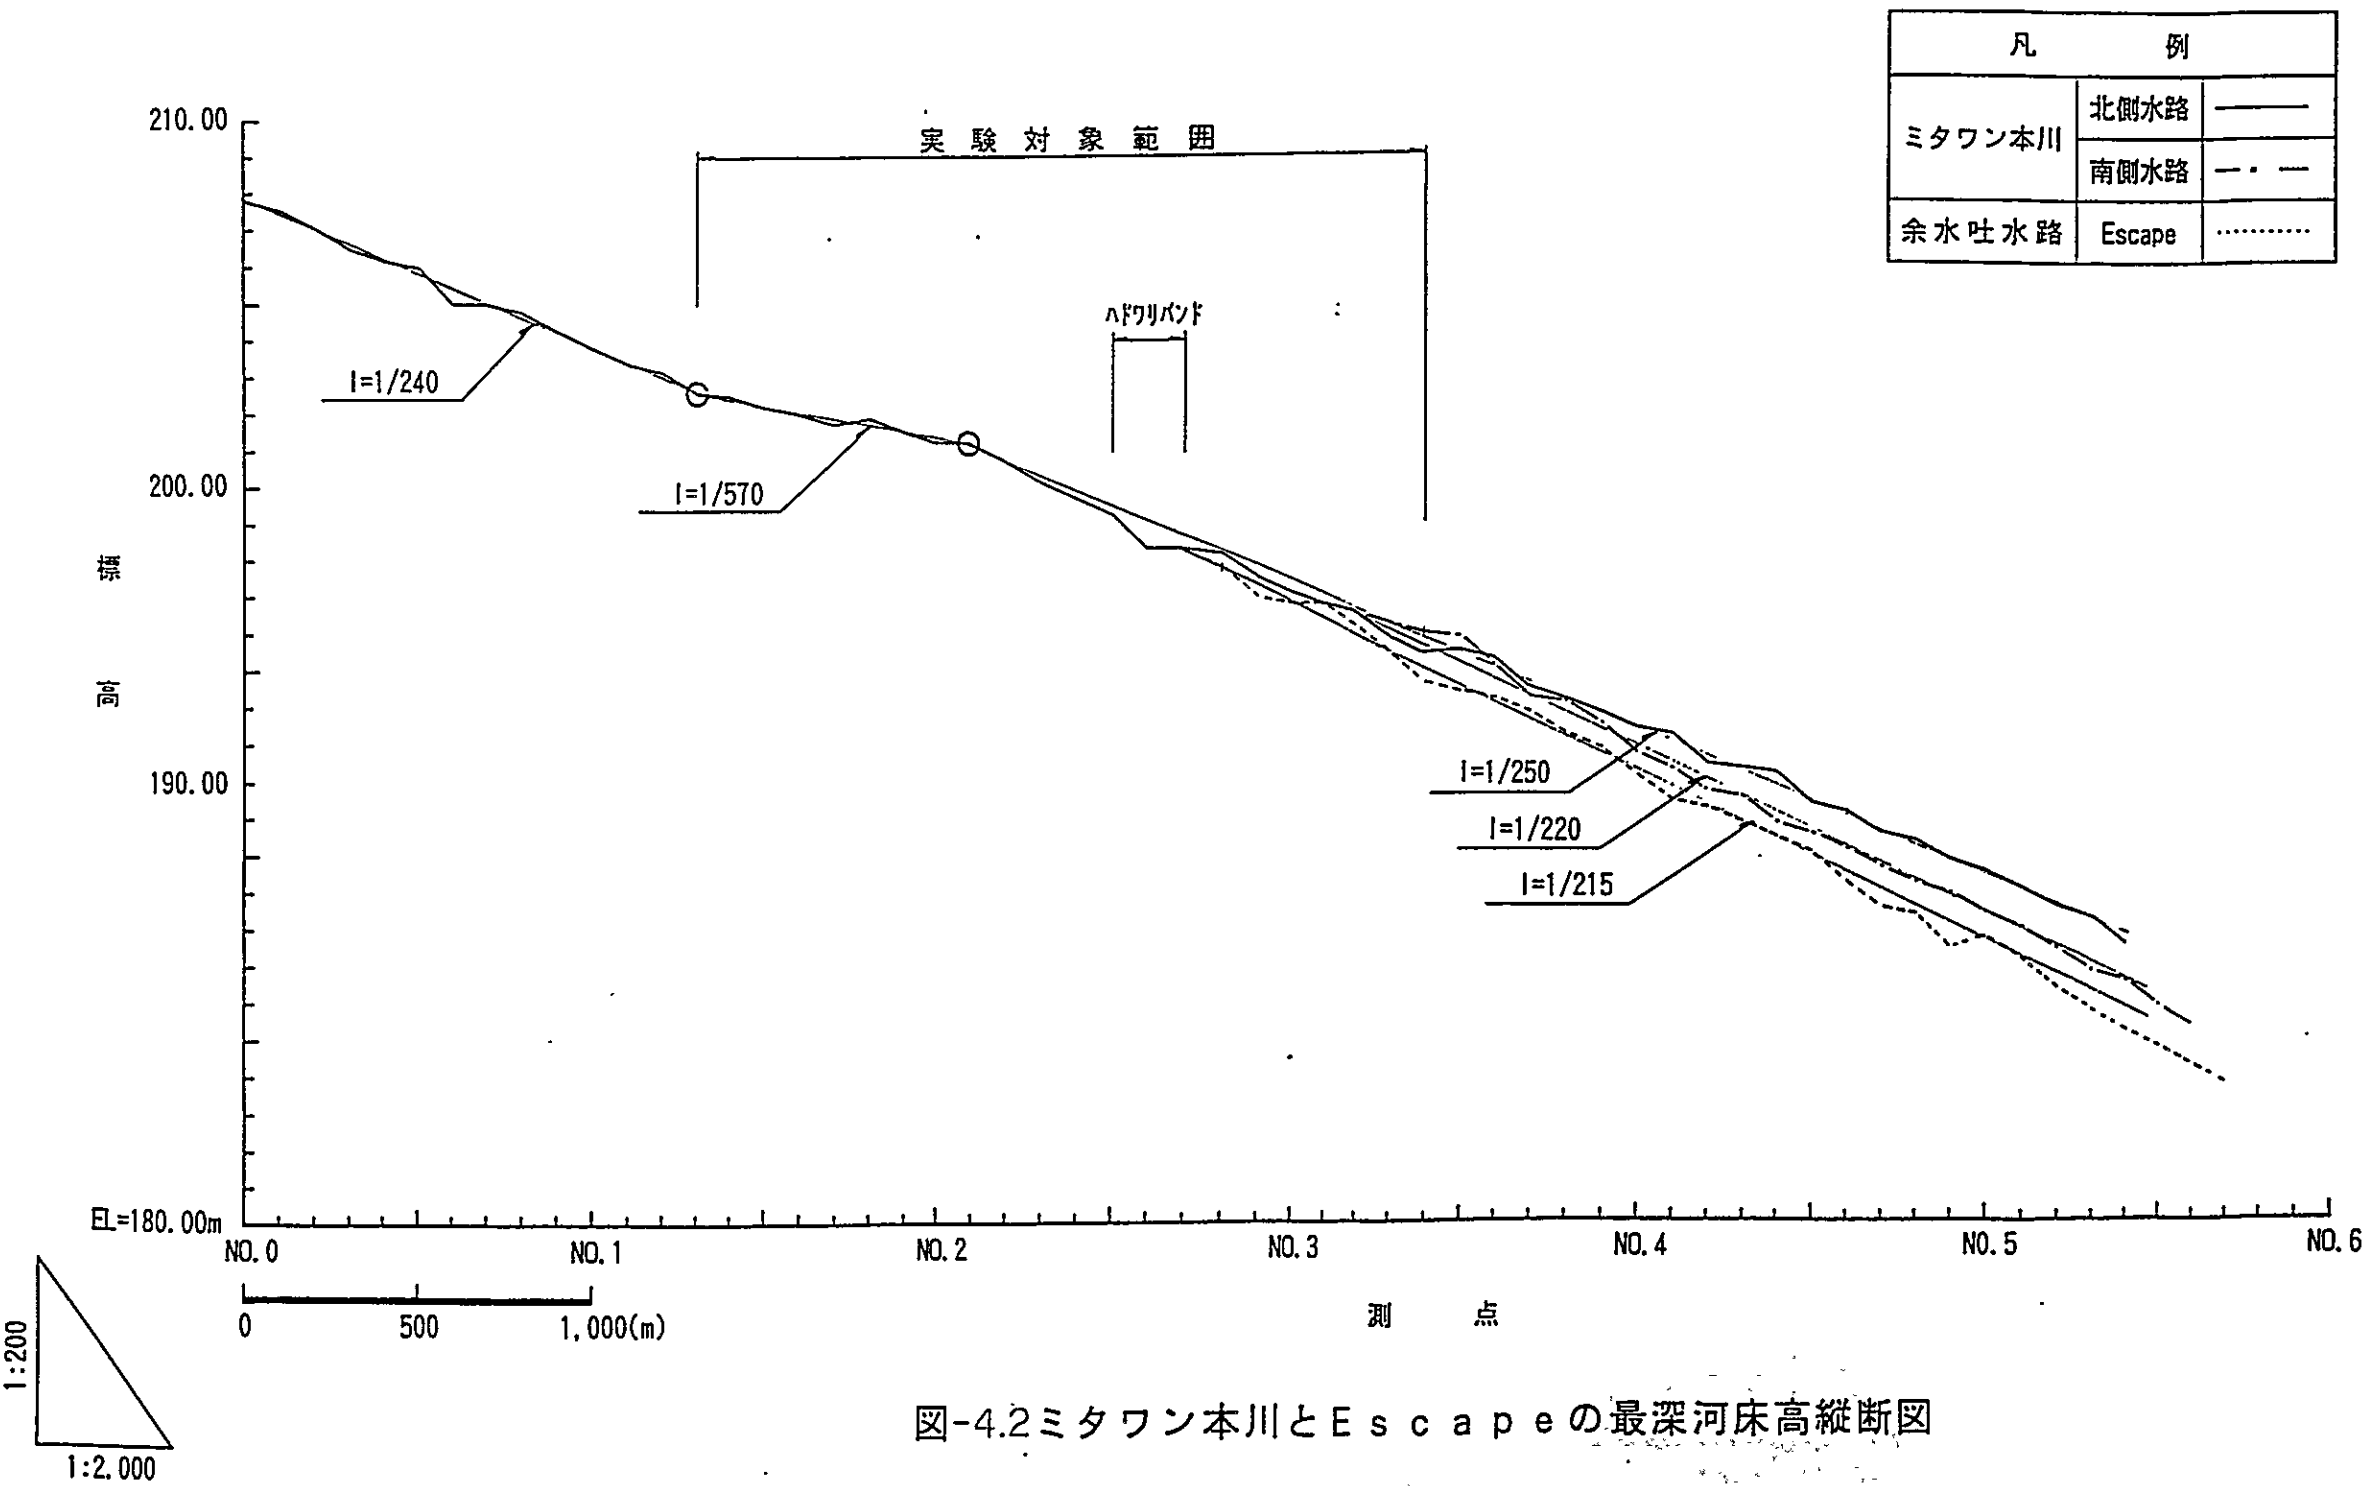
ミタワン本川とEscapeの最深河床高縦断面図
